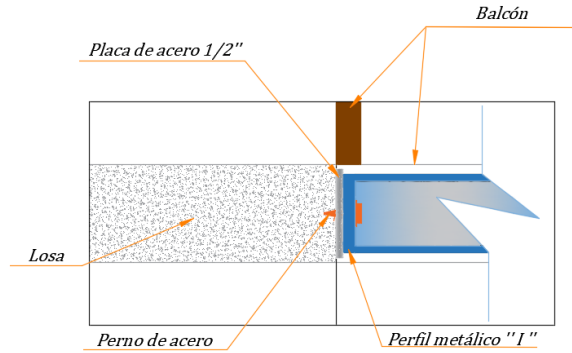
Corte de sistema constructivo de Doble Fachada
